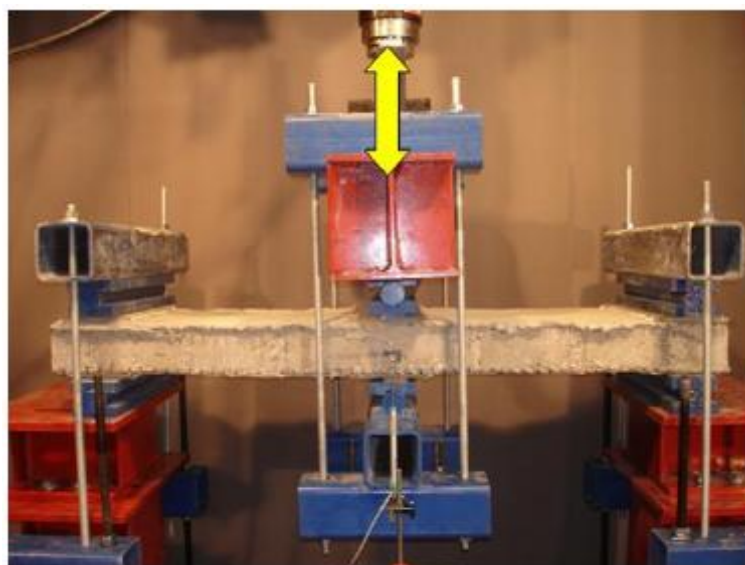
Ensaio de flexão (carregamento fora do plano) [44]
